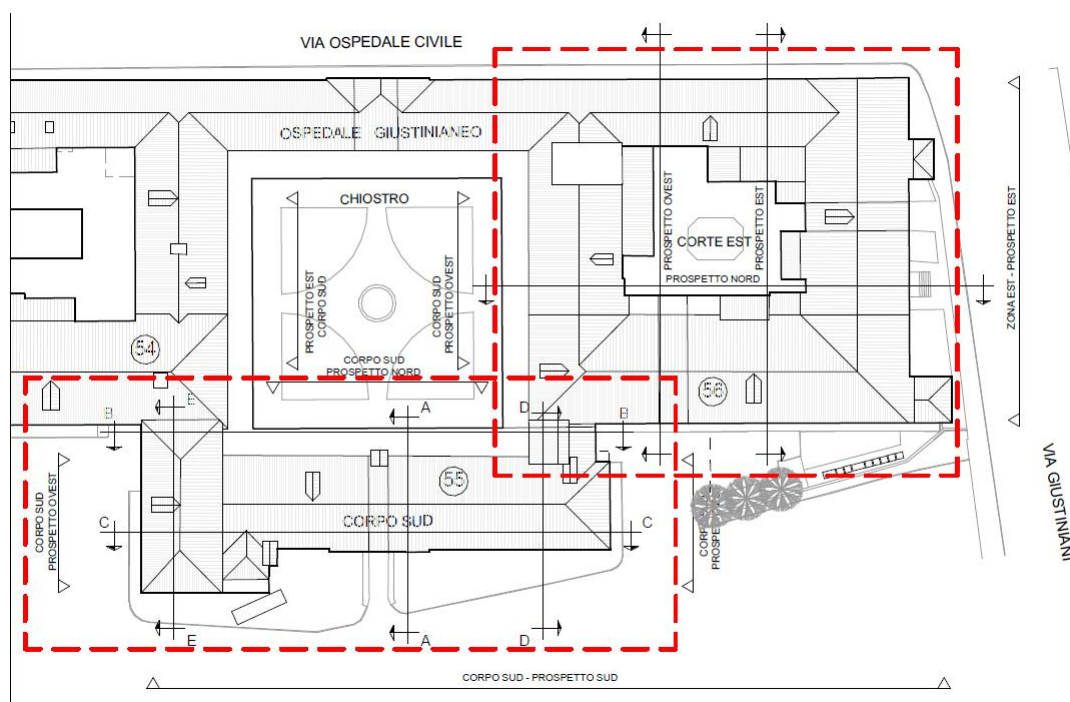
Key plan con individuazione aree di intervento del complesso Giustiniano.
